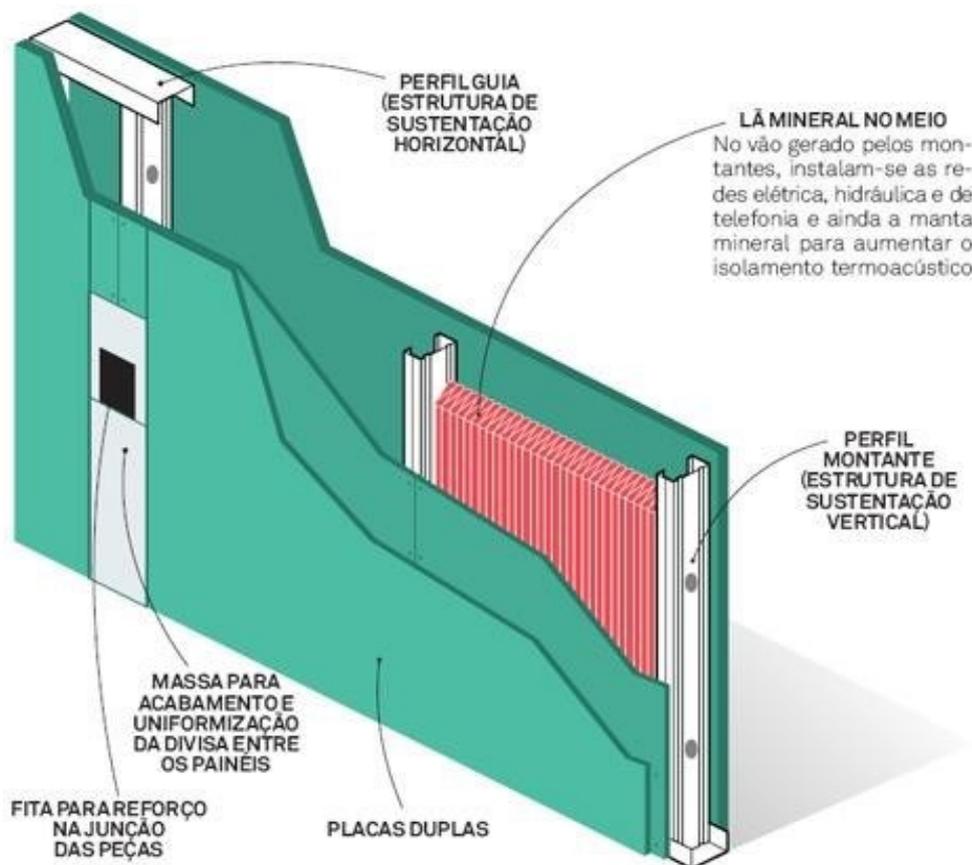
Parede de Drywall (ABRILCASA, 2011)
